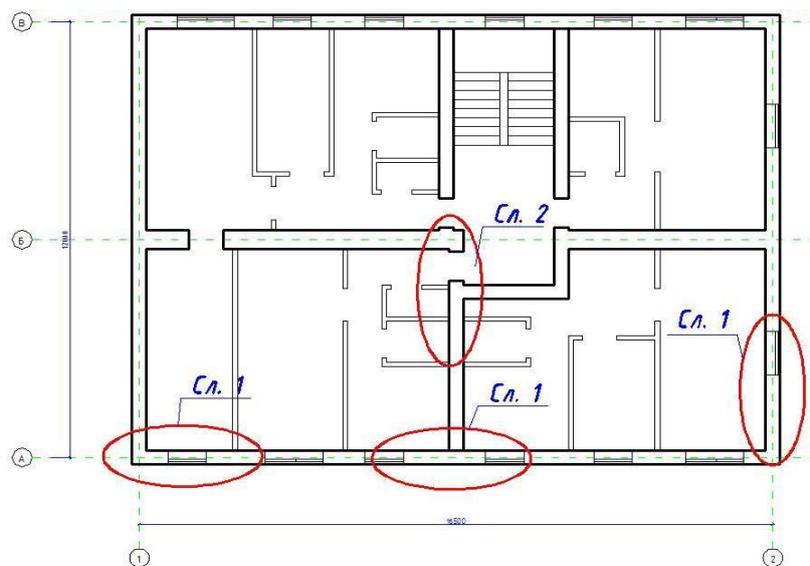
Схема расположения локальных разрушений типового этажа кирпичного здания
